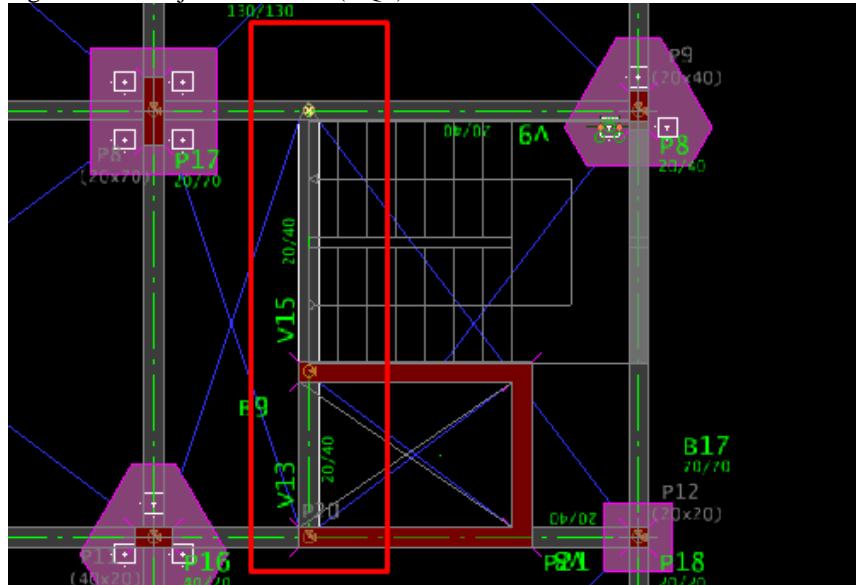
Projeto Estrutural (CAD) Primeiro Pavimento.
